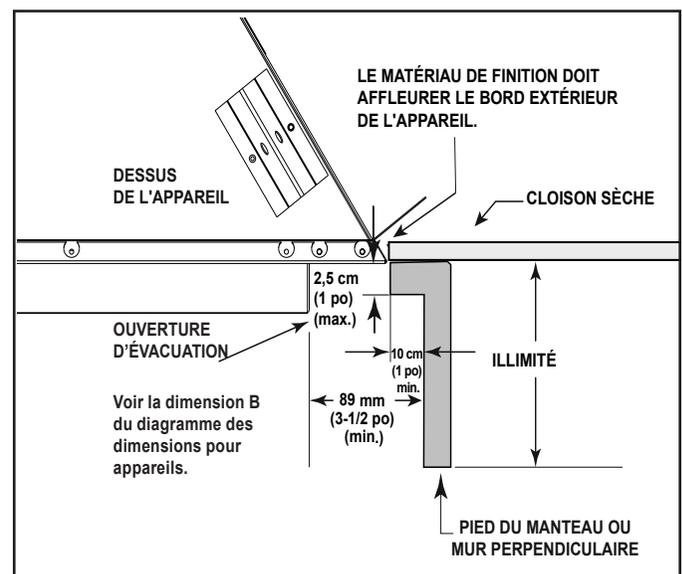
Dégagements du pied du manteau et des parois (acceptable de part et d'autre de l'ouverture)
